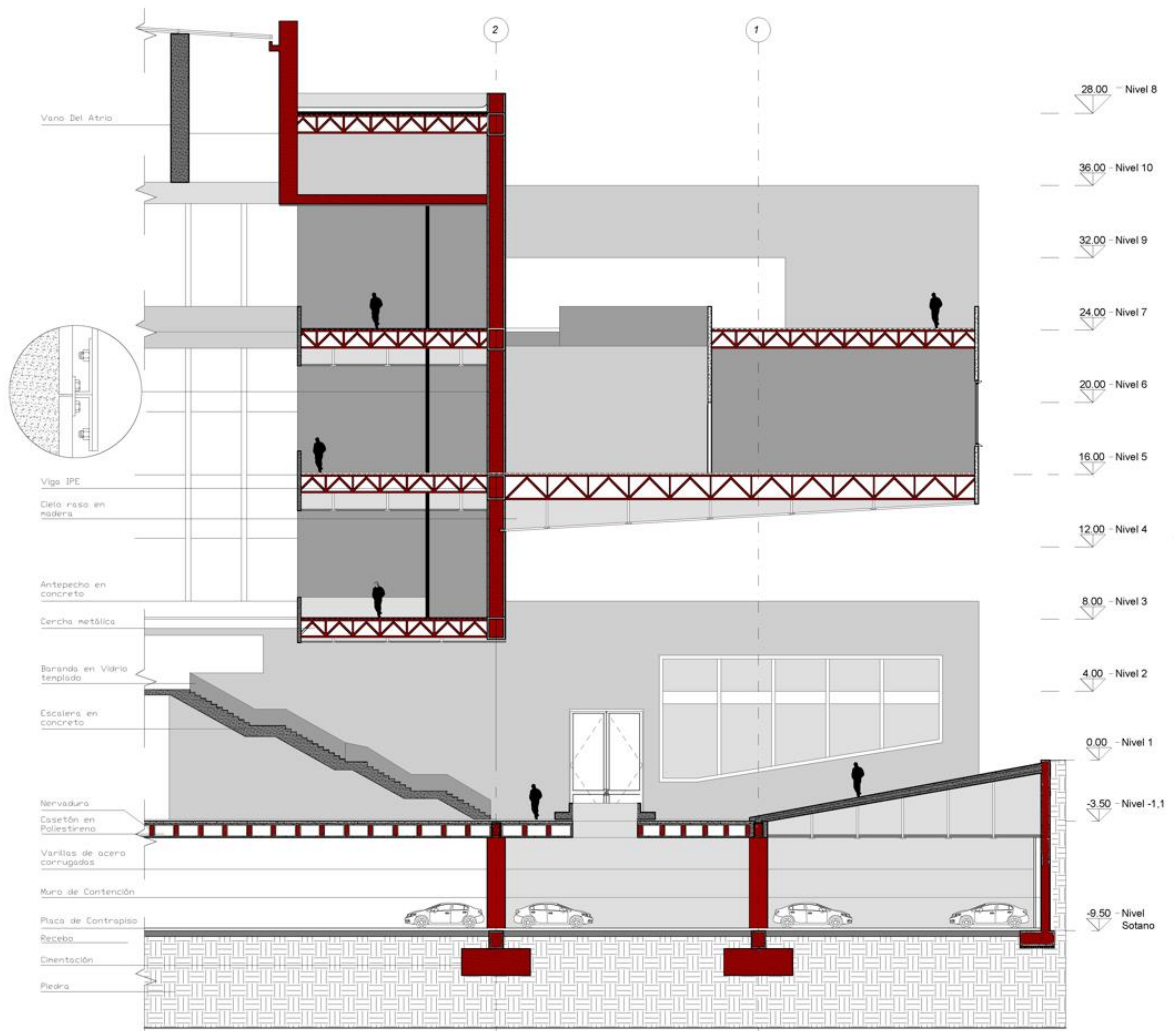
Corte Por Fachada. Espacialidad interna sistema estructural
